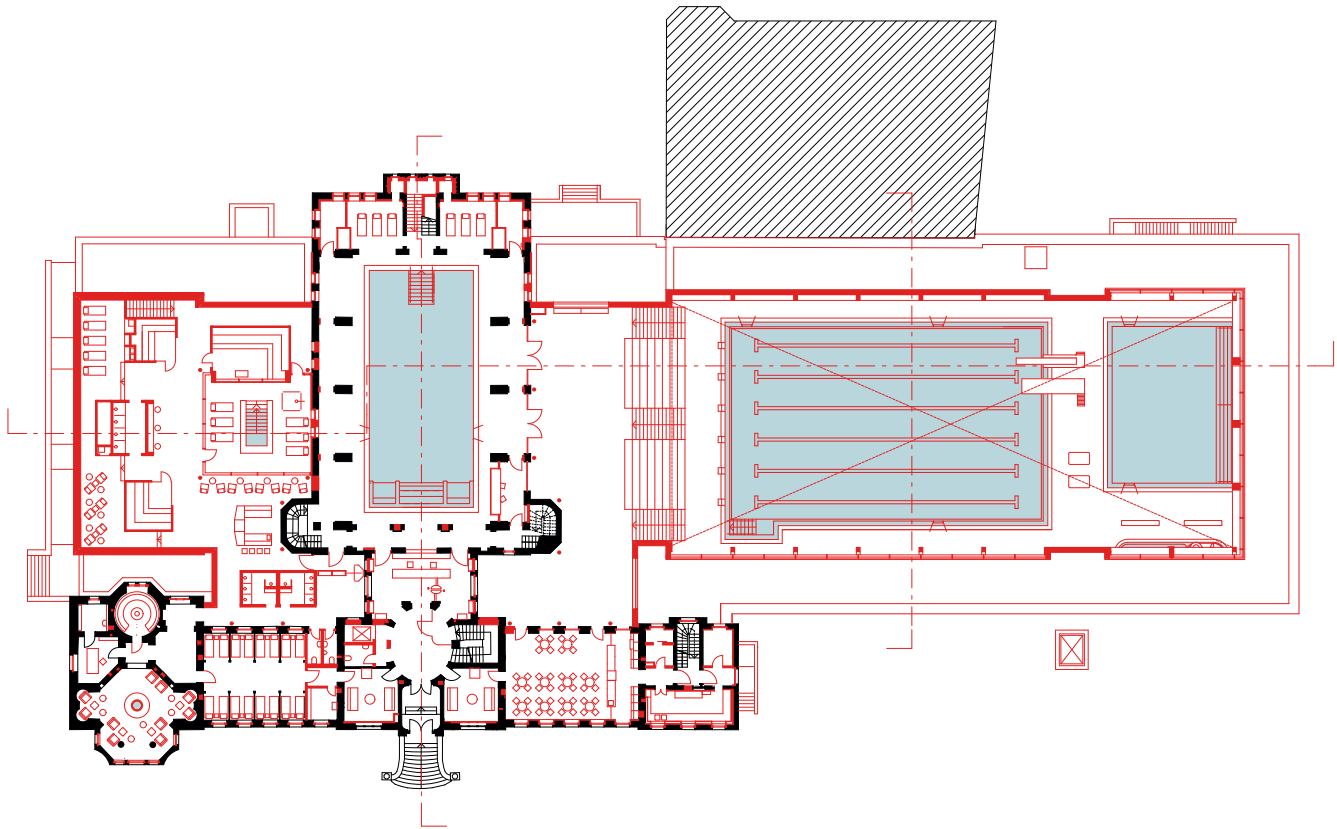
Stadtbad Gotha, Grundriss EG, 2014
